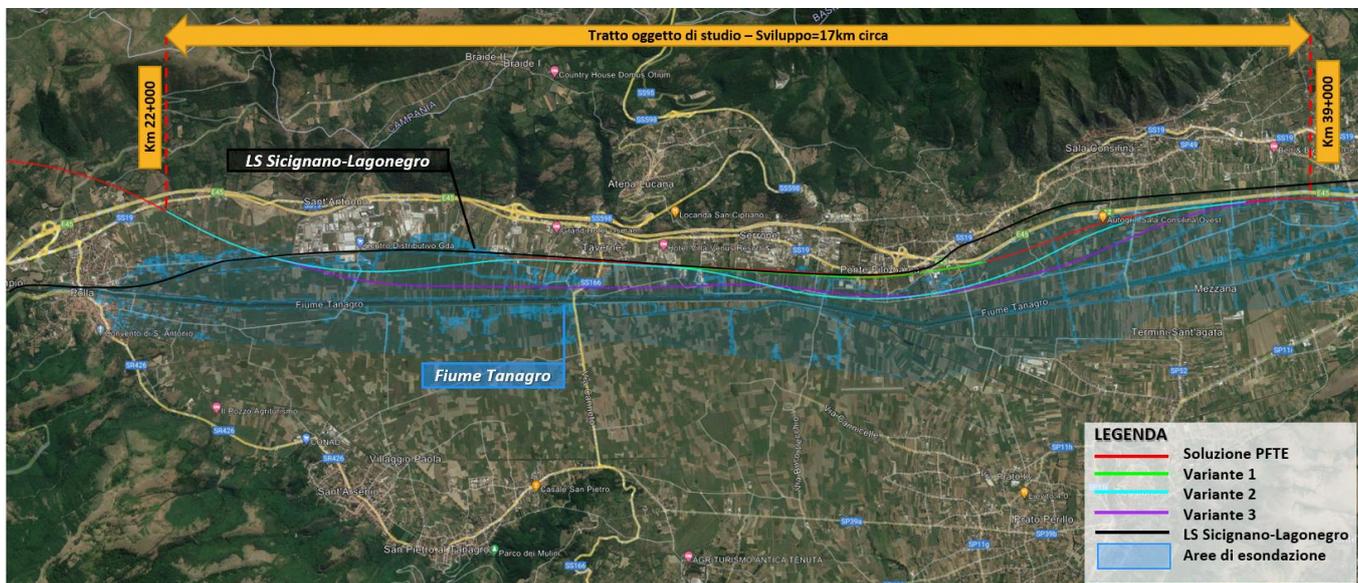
Stralci corridoio B con individuazione delle tre soluzioni alternative
